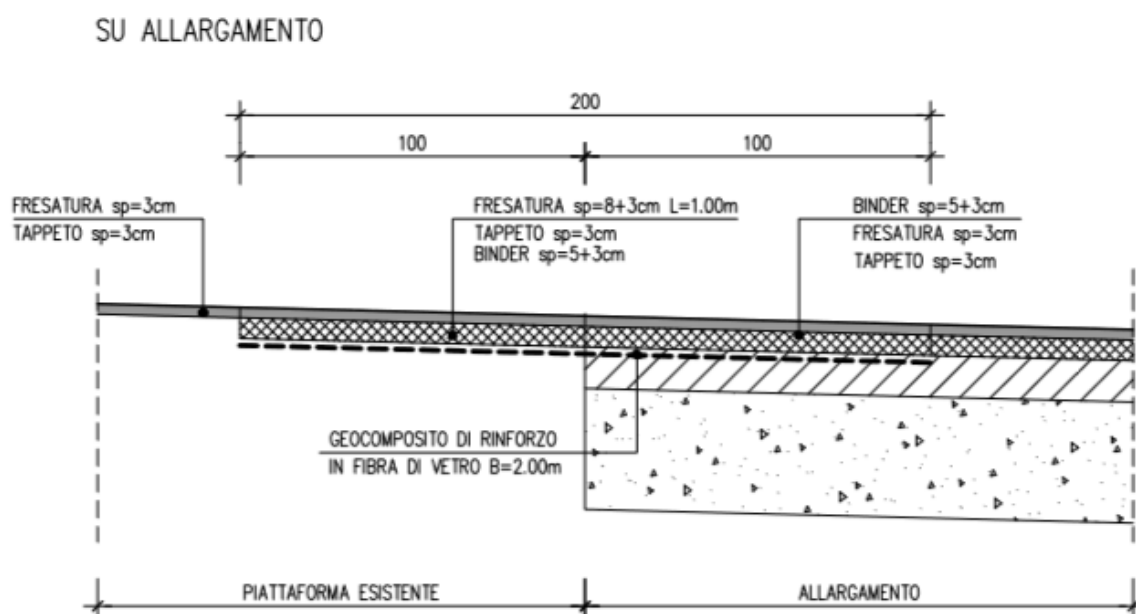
Pavimentazione stradale – Particolare zona di allargamento
